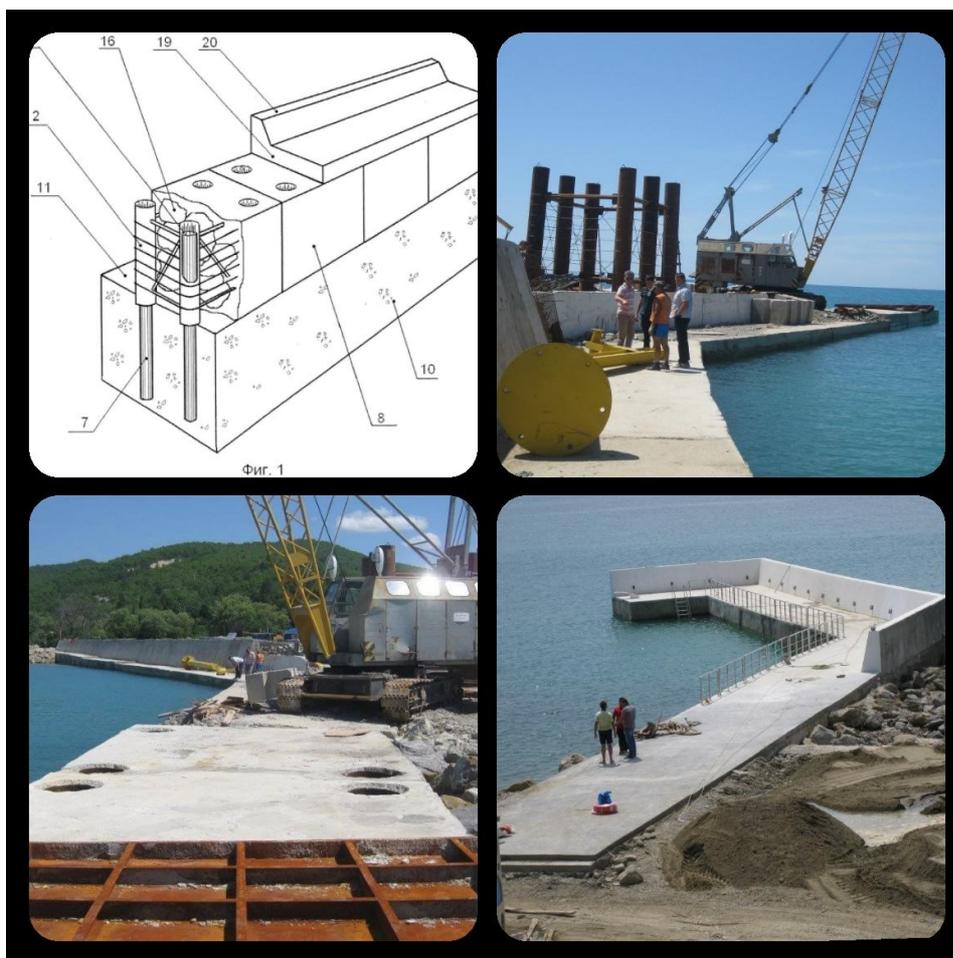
Гидротехническое сооружение вертикального профиля на свайном основании
